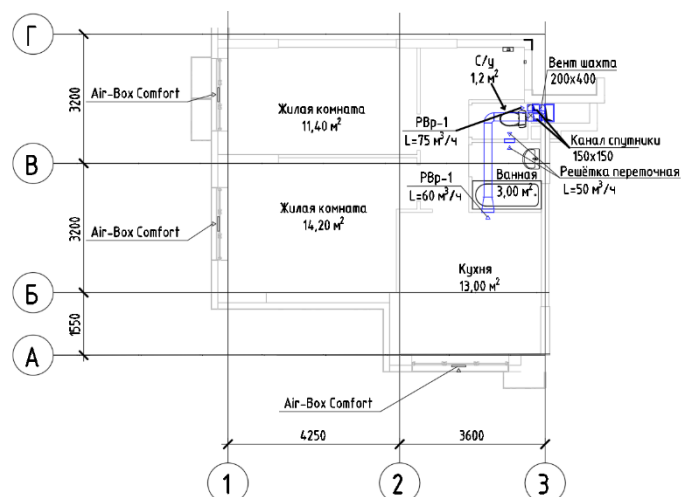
Фрагмент плана обслуживаемого этажа
